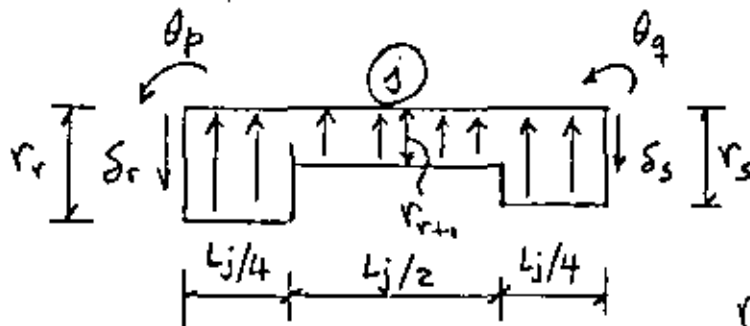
Barra con cargas repartidas en la cimentación. Apoyos continuos.
